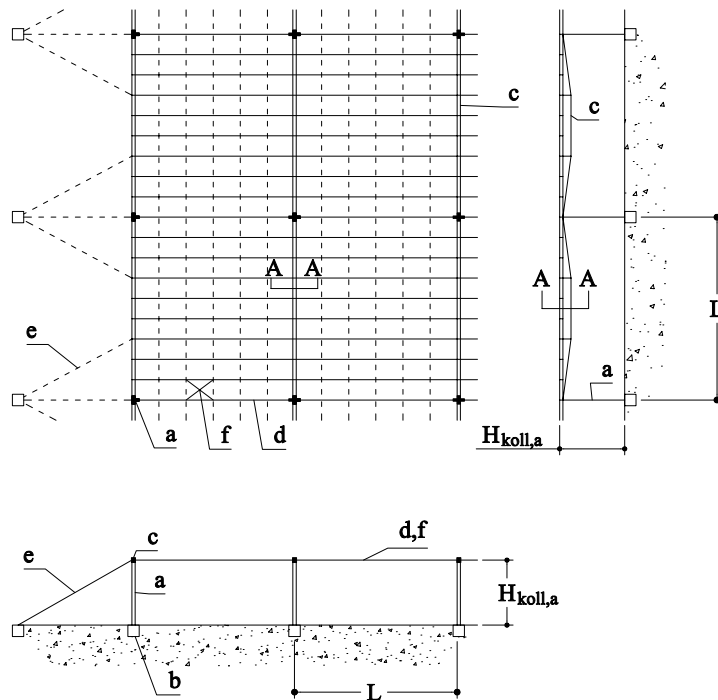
Vordachkonstruktion mit Glaseindeckung. Konstruktionsdetails: Stahl- (oder Betonfertigteil-) Stützen (a) in Betonfundamenten (b) im quadratischen Abstand von $L=9$ Metern tragen in einer Richtung unterspannte Träger (c) (Querschnitt A-A). Dazwischen hängen in Querrichtung im Abstand von 1 Meter Flachstäbe (d) mit Abspannungen (e) am äußeren Dachrand. Auf die Flachstäbe (d) sind 4 mm- Glasscheiben (f) aufgeklemt, eine Lage (wie im Querschnitt A-A gezeigt) oder zwei Lagen (/Schlaich 1995/).
